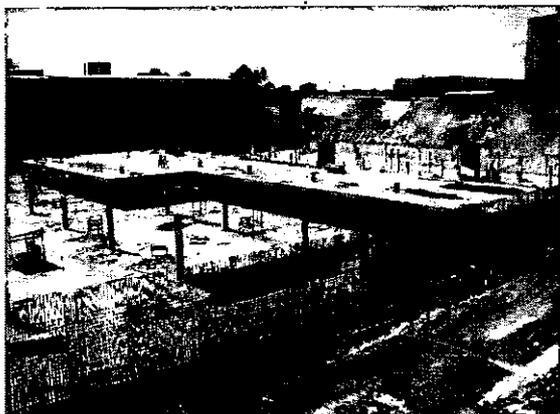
Parte do trecho V do teto do 2º subsolo
